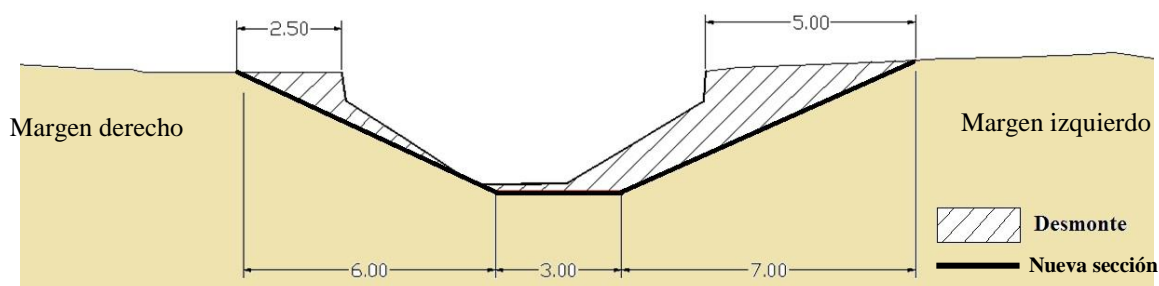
Perfil tipo para el tramo comprendido entre las secciones 290 y 250. Elaboración propia
